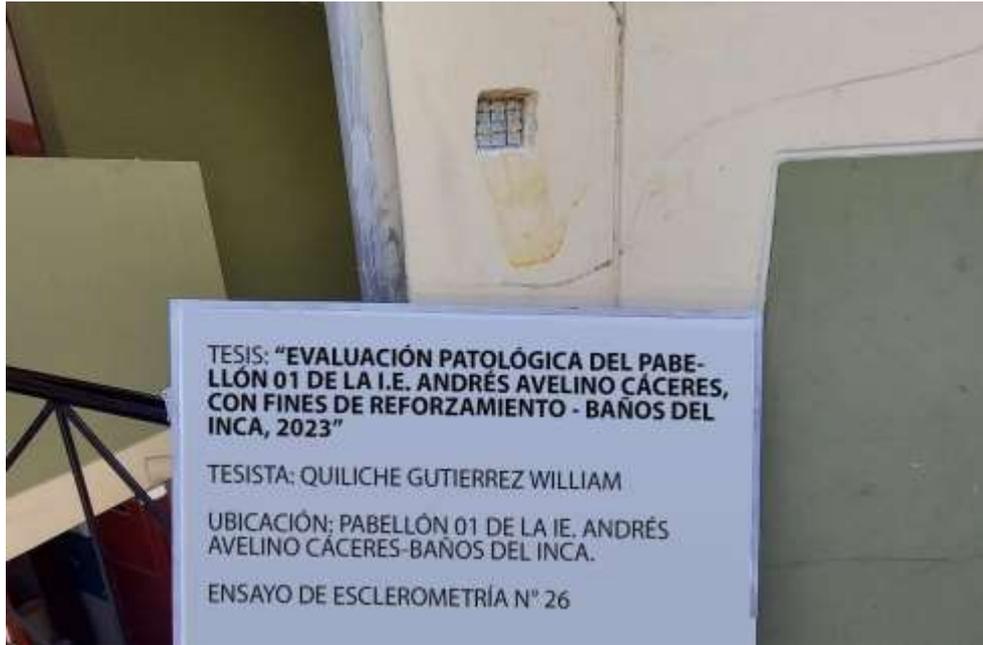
Ensayo de esclerometría en una de las columnas del segundo piso.
